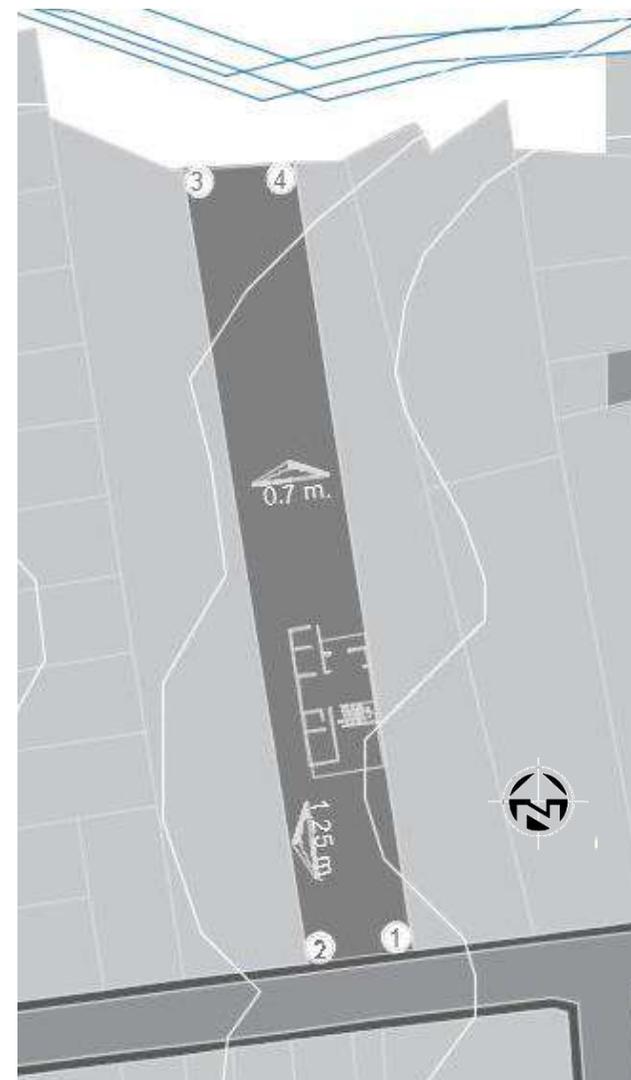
PLANTA DE UBICACIÓN DEL LOTE Y CONSTRUCCIÓN EXISTENTE.
